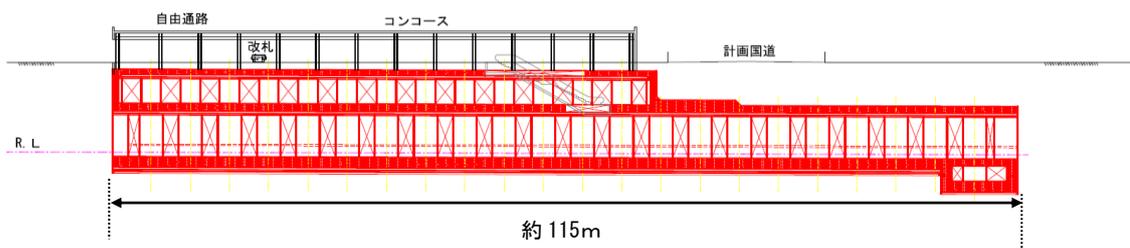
(1) 駅部縦断面図 (川崎大師駅部)
